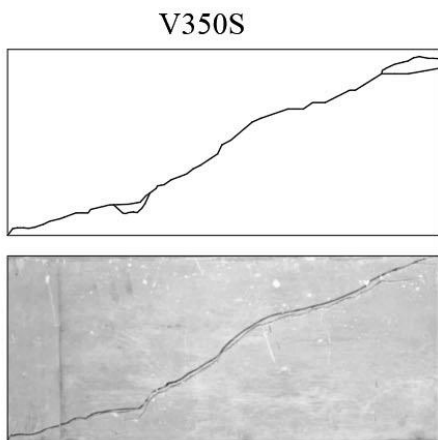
Padrão de fissuração da viga V350S.
